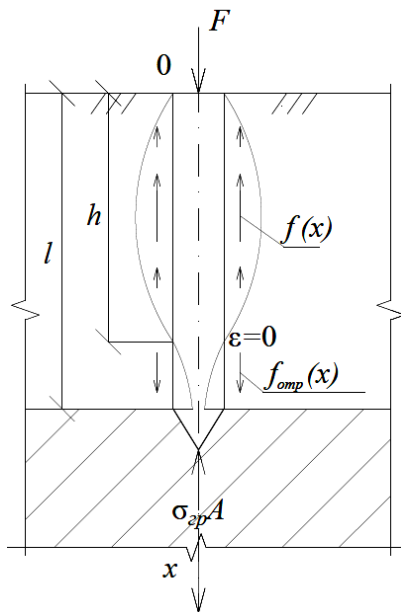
Расчетная схема работы сваи-стойки в расчетах на осадку
